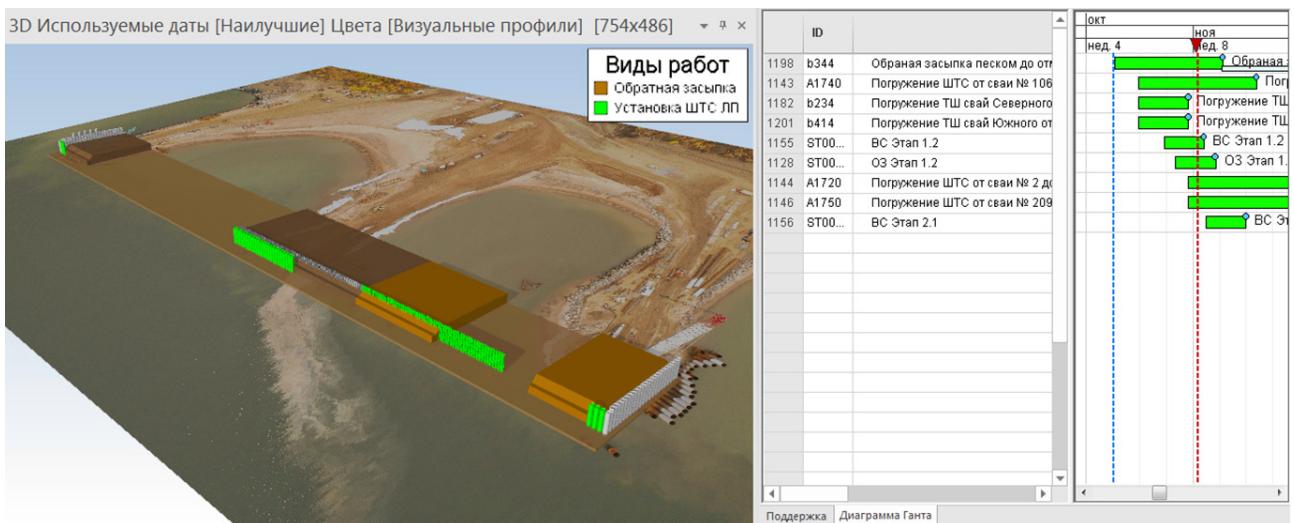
Отсыпка насыпи до отм. –2,500, погружение свай лицевой стенки, погружение временной стенки из шпунта Ларсена
